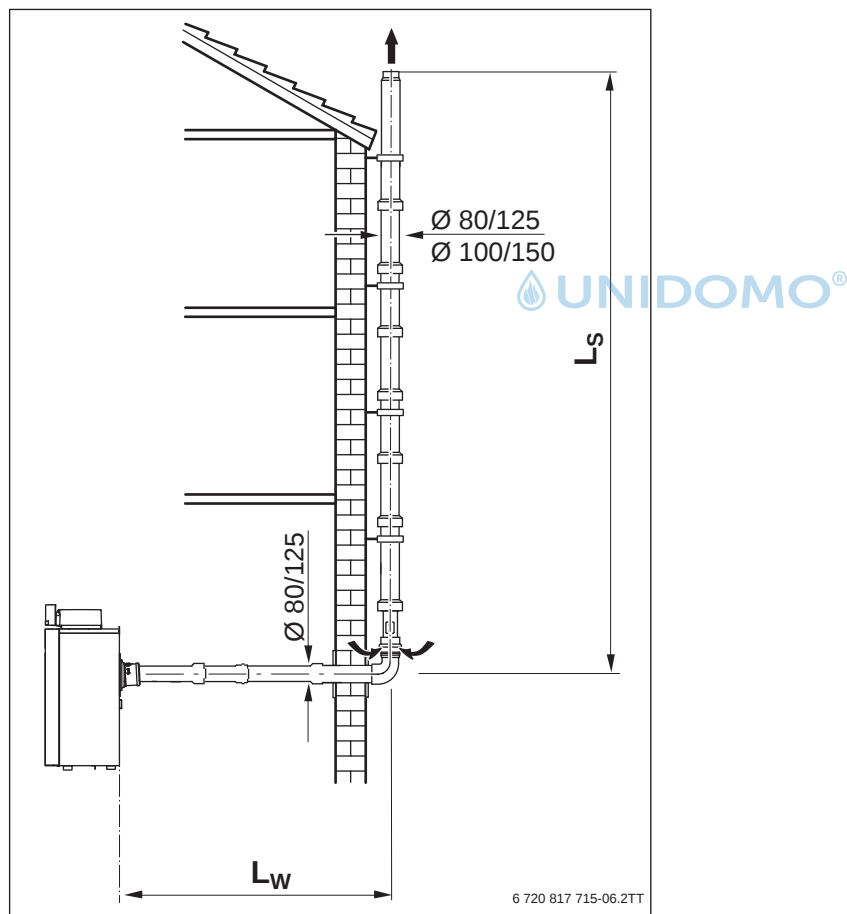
Doppelrohrführung an der Fassade ($C_{53(x)}$)
